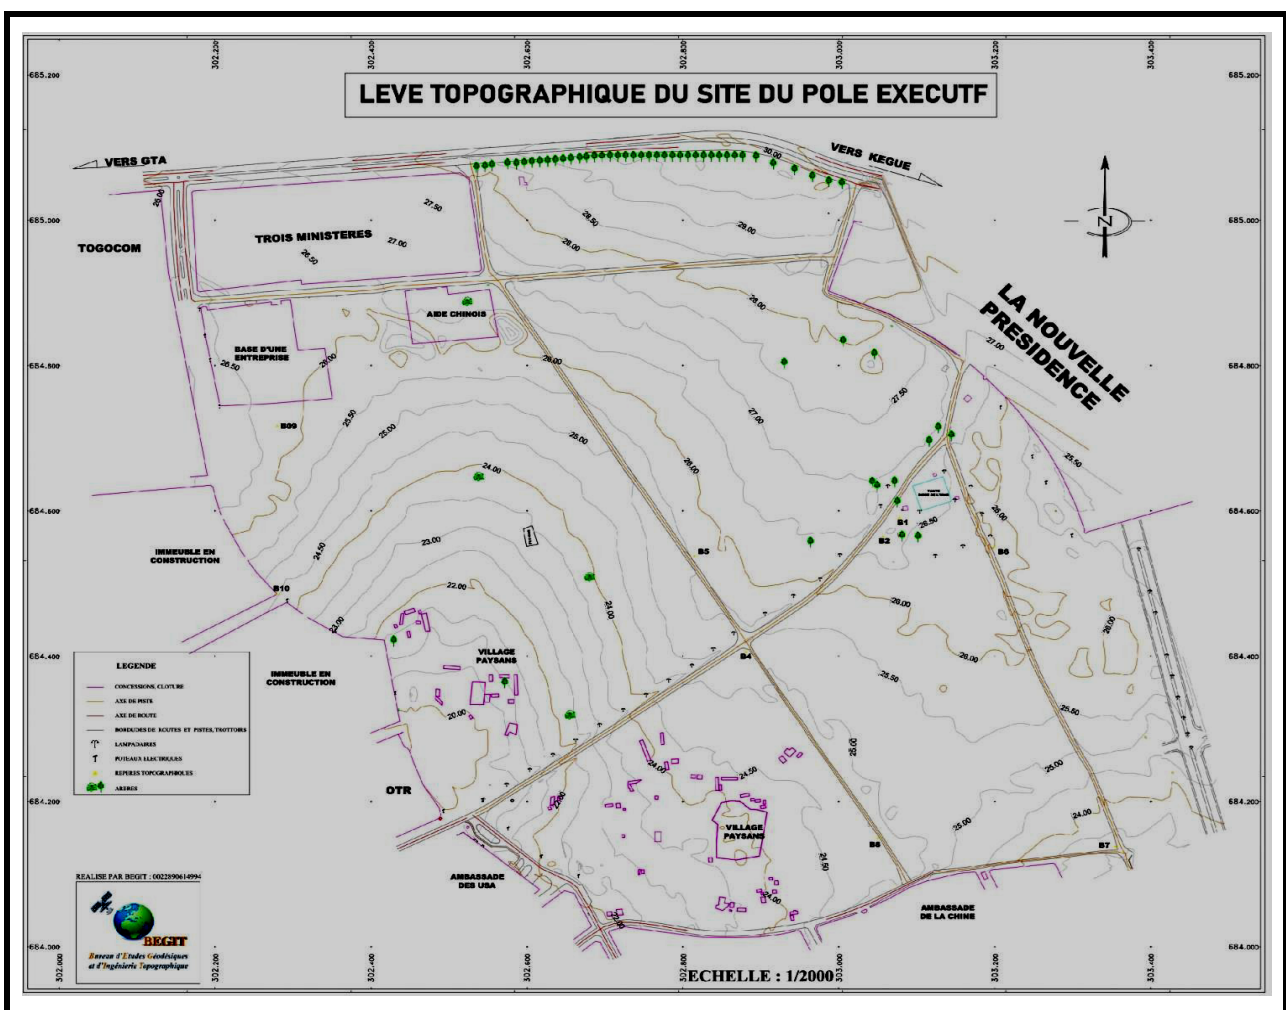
Extrait topographique du site (Plan des courbes de niveau)
